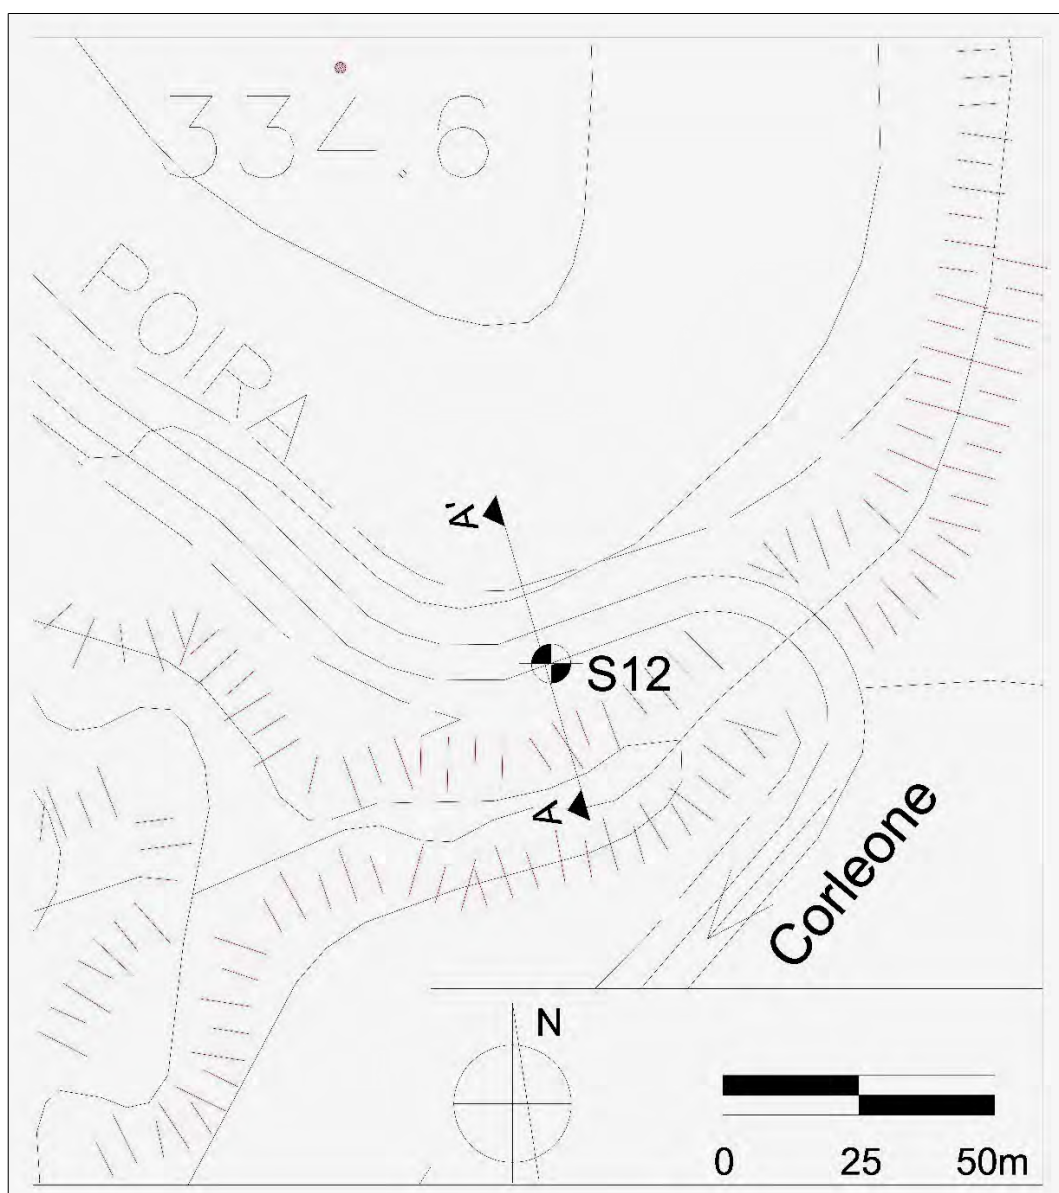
Planimetria con indicazione della zona oggetto di interesse al km 18+400.
